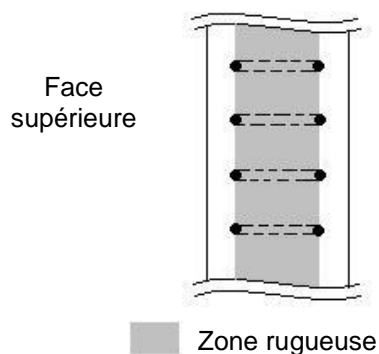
Rugosité des poutres de planchers avec cadres dépassants
